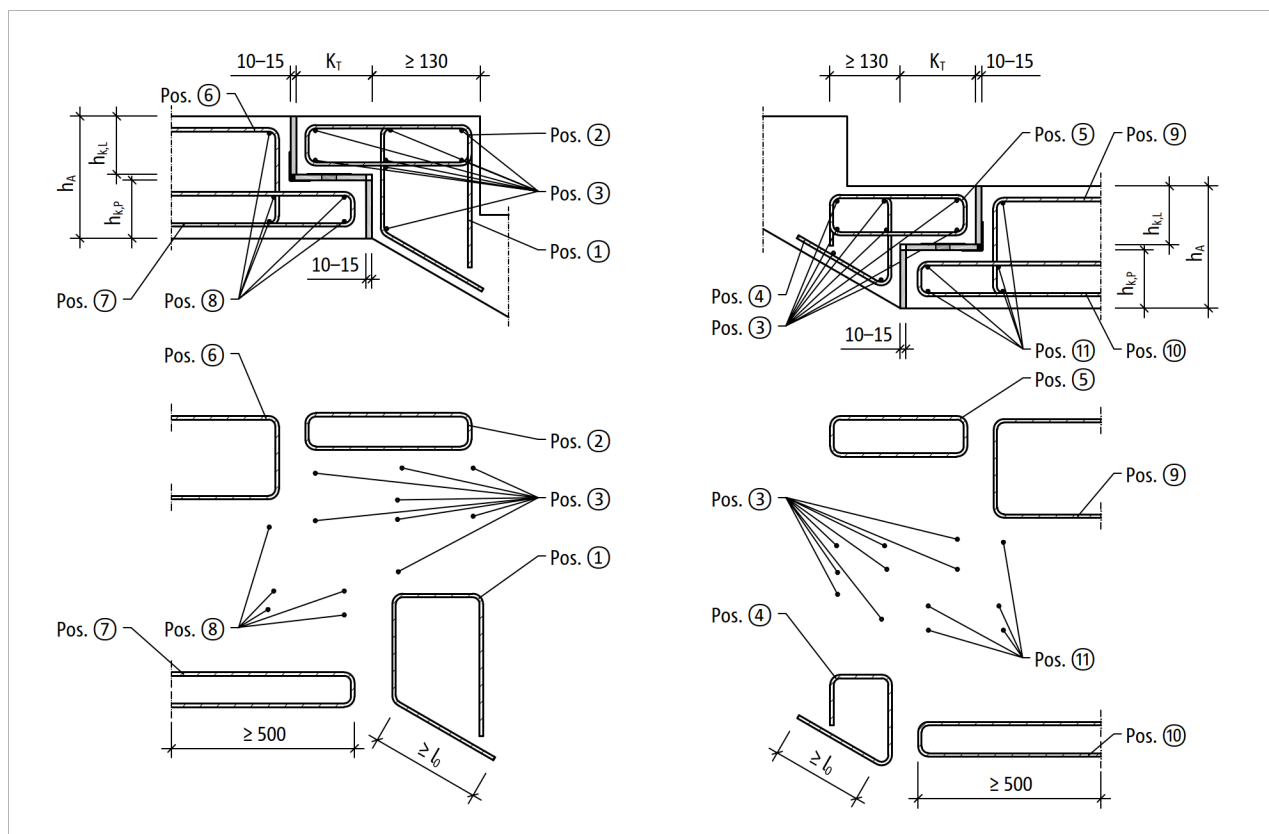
Schöck Tronsole® Typ F: Bauseitige Bewehrung bei bündigem Anschluss
